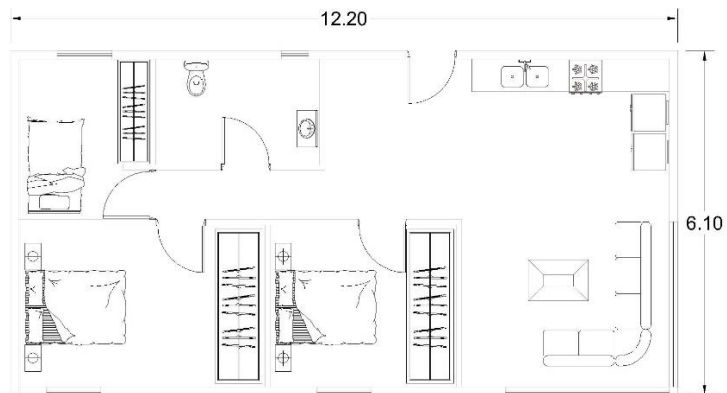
Planta de distribución arquitectónica, con dimensiones generales de 12.20 m. de longitud por 6.10 m. de ancho y un total de 74.42 m² de construcción (CASAS CUBE, 2016).
